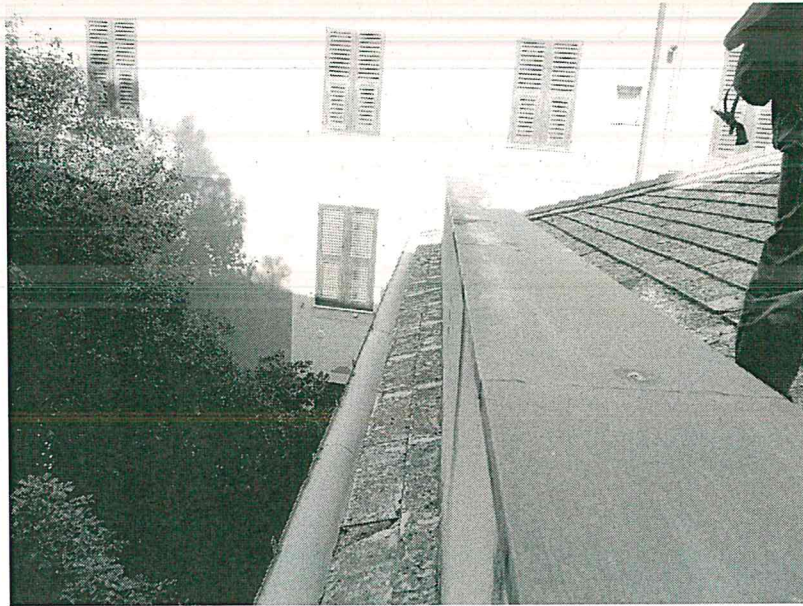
Dettaglio del muretto d'attico, dell'aggetto della copertura e del canale di gronda
